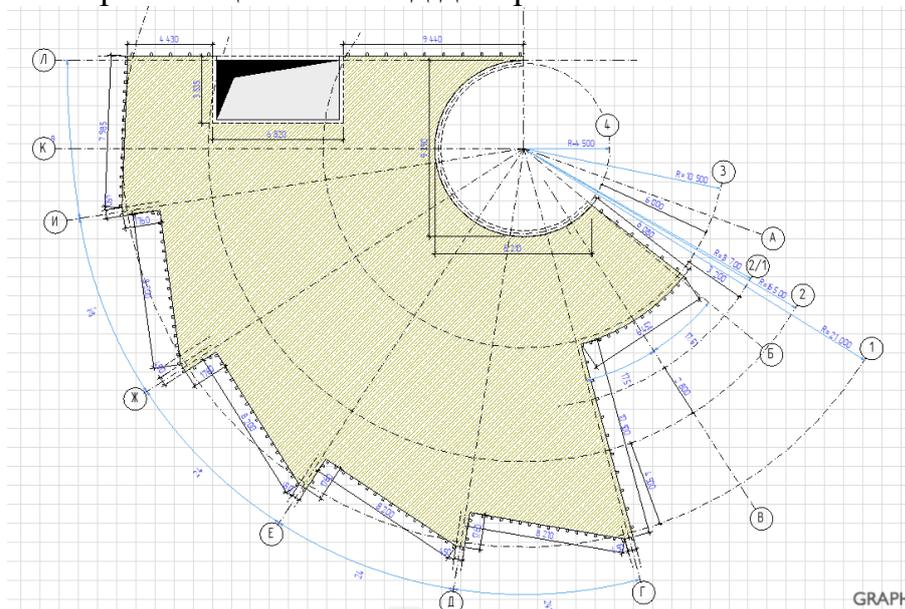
Компонировочная схема плиты перекрытия
